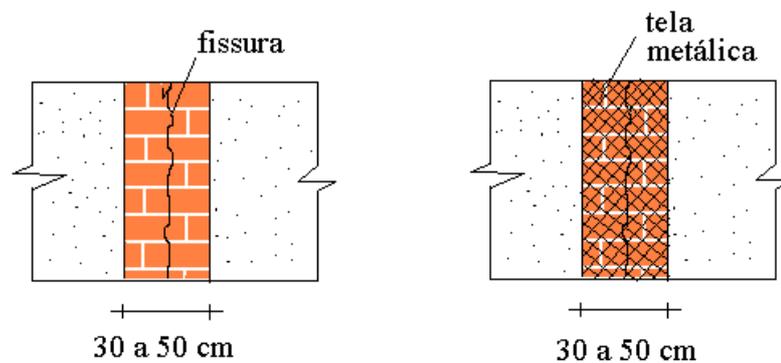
Técnica da tela metálica para correção das fissuras
